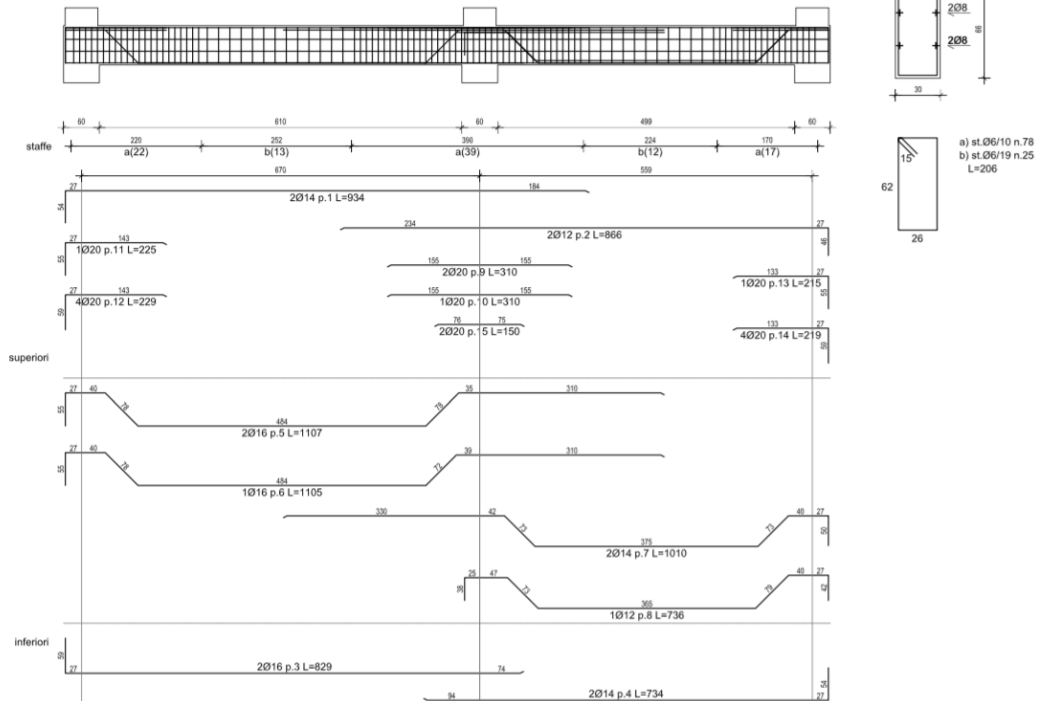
Armatura longitudinale e trasversale per travi di tipo 1 (I livello).
